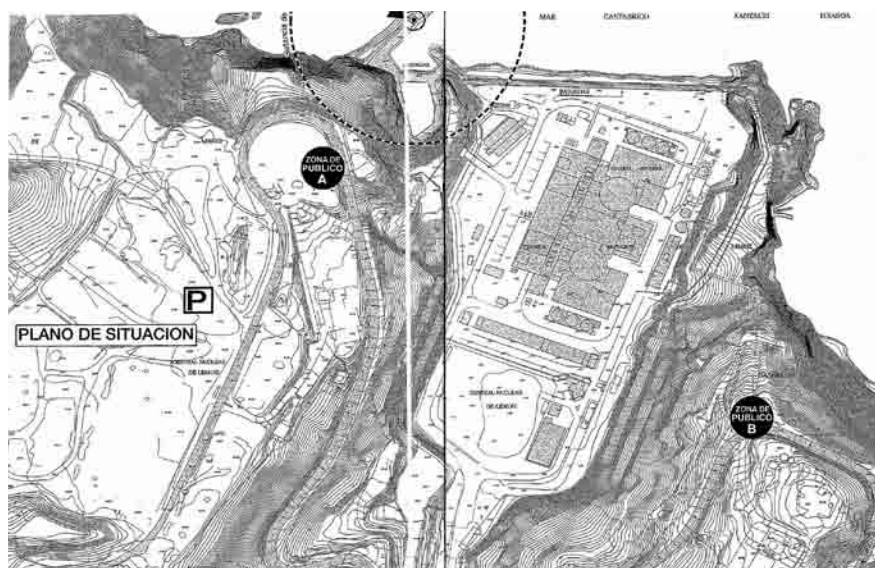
· Plano de localización. Publicado en la entrevista de *Papers s'Art*. 2001.
